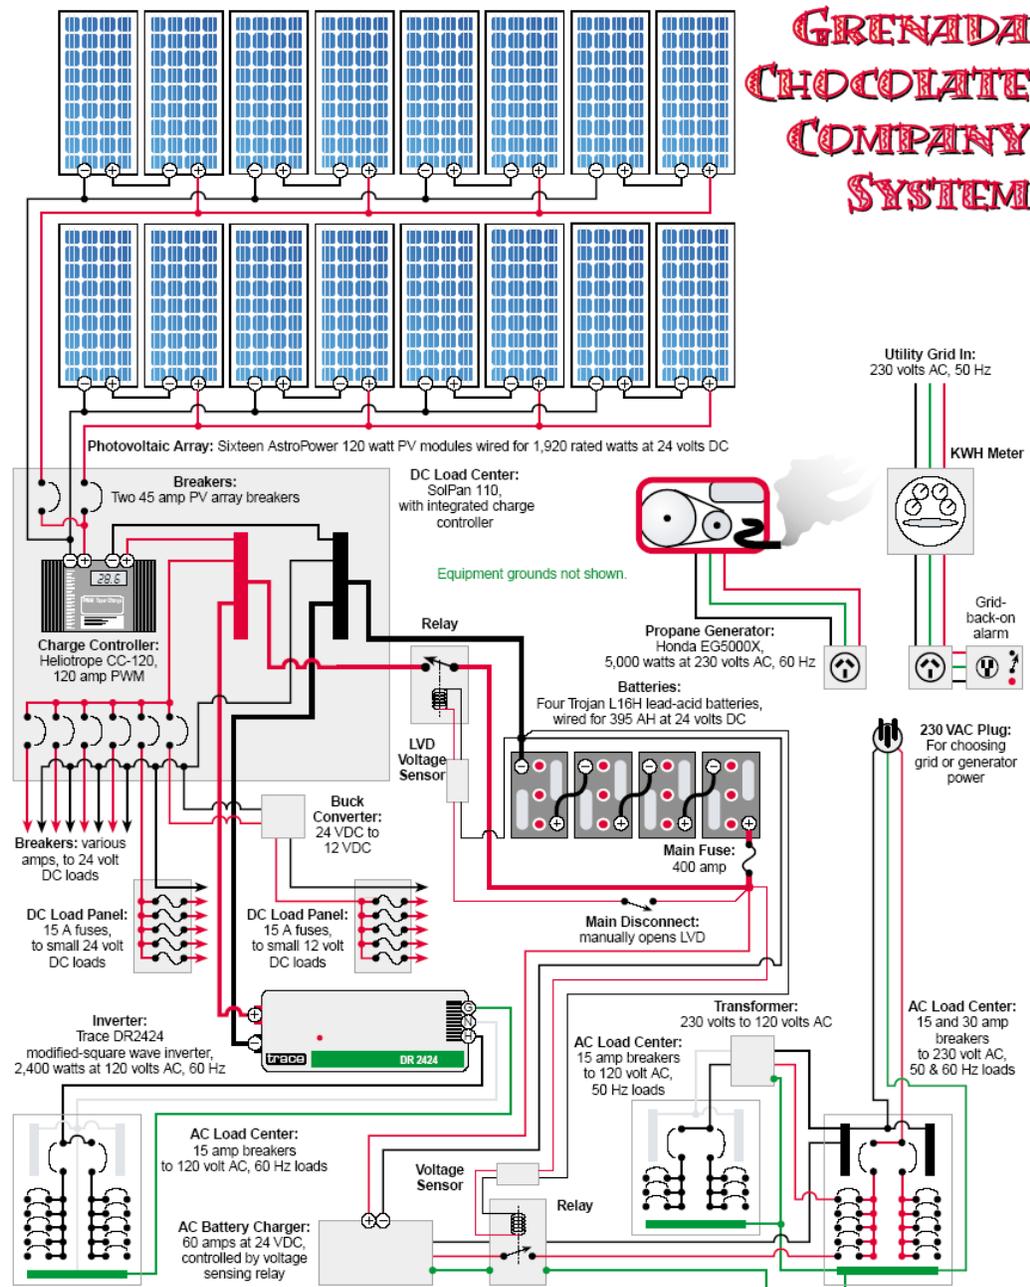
Sistema eléctrico aplicado en la planta
